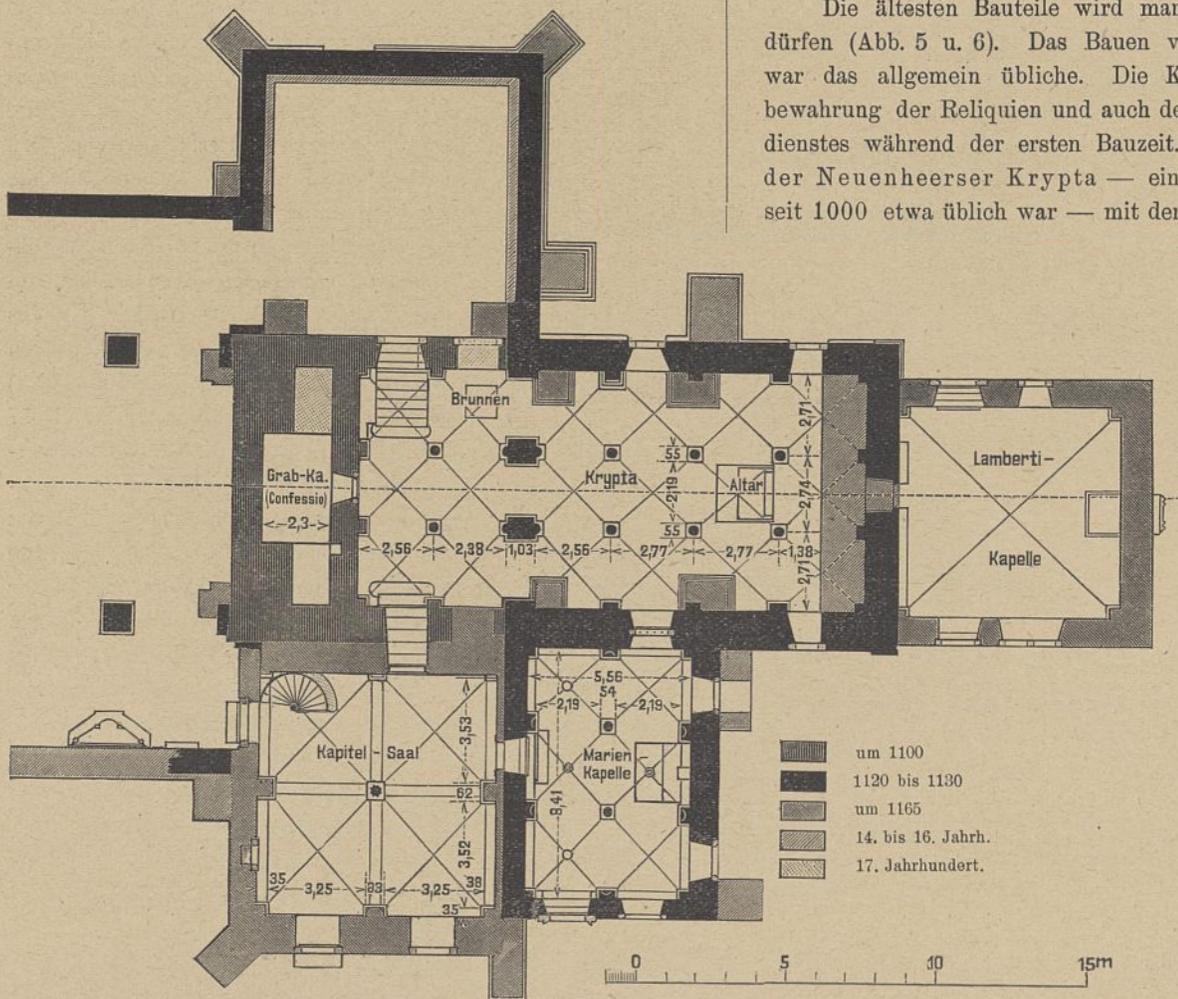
Grundriß der Krypta und anstoßenden Räume.
